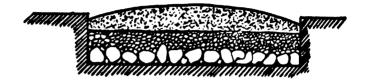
Corte de un pavimento tipo Tresaquet.
